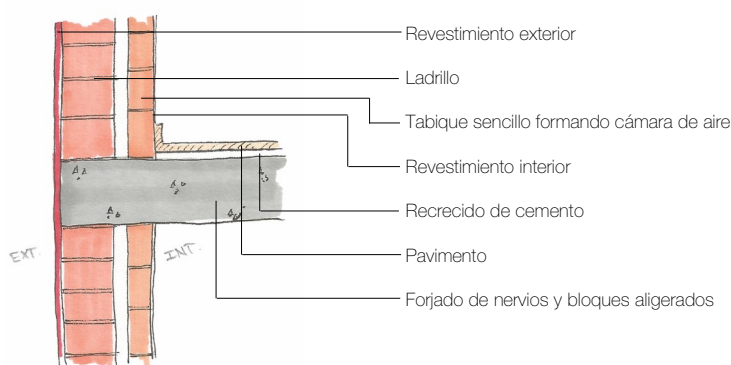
Detalle en sección de encuentro fachada con forjado (autoría propia).
